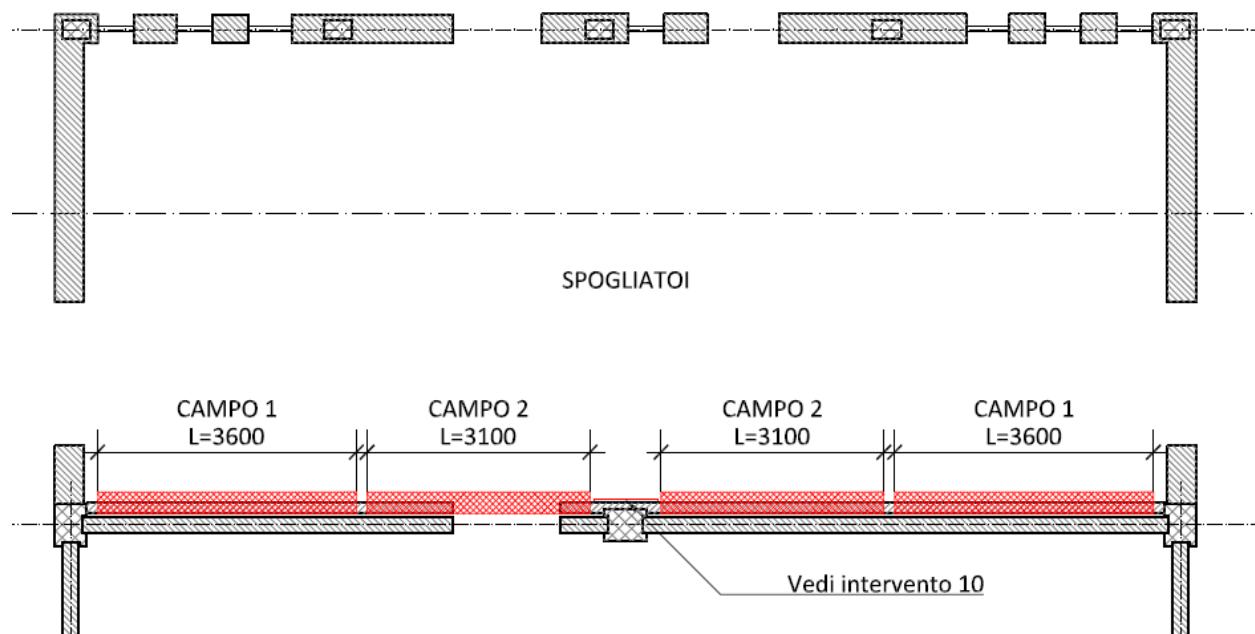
Intervento 09 – Individuazione in pianta dell'intervento
